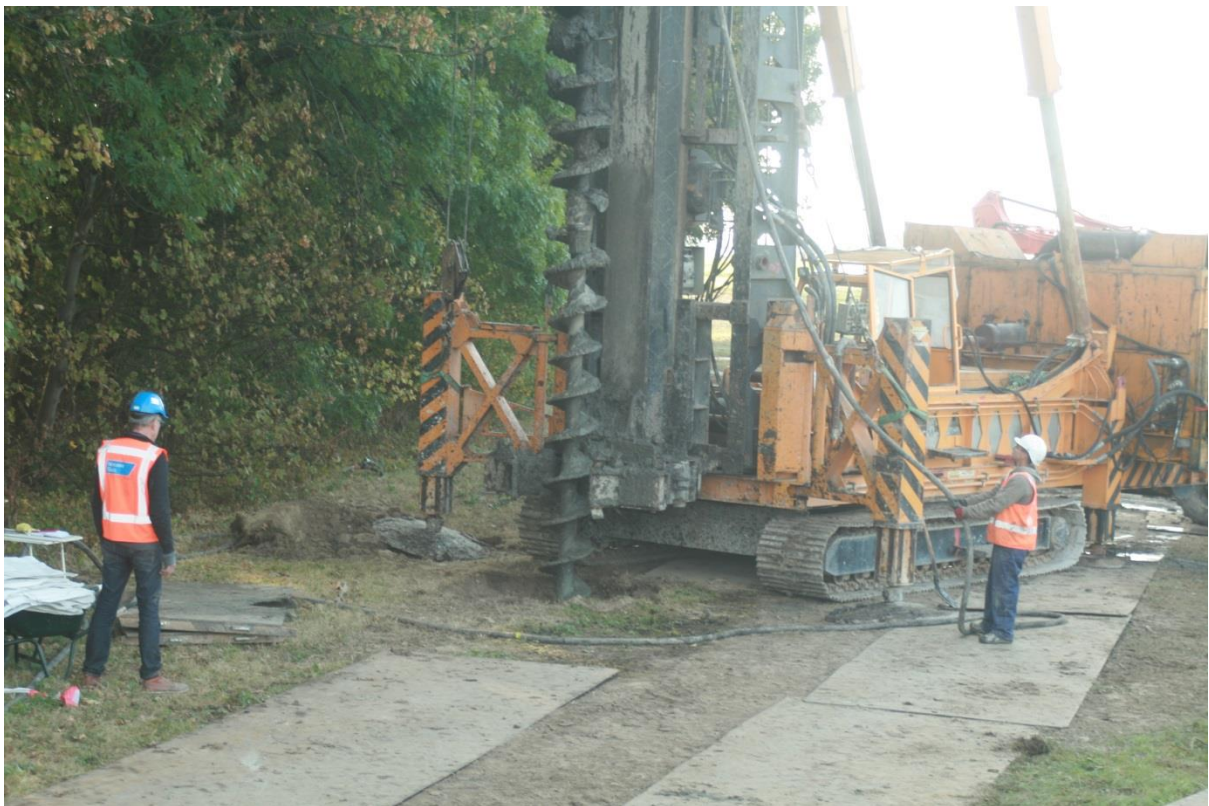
en 24. De avegaarbooropstelling op de locatie A33. Avegaarbooropstelling met een holle opening in de centrale boorbuis waar via een slang de vloeibare dämmer in het boorgat kon worden gespoten om daarmee het gat af te dichten. Het uitharden van der dämmer duurde enkele dagen. Foto's: Nieuwe Sluis Terneuzen - Mark Neelemans Fotografie.
